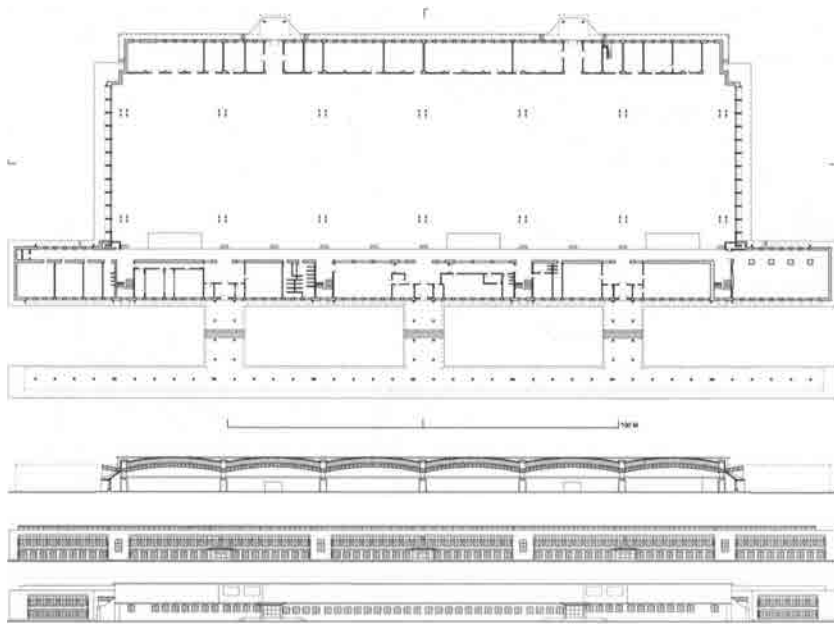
, Fig. 37, Fig. 38 y Fig. 39 Nave I de talleres. De arriba a abajo: planta baja, sección longitudinal, alzado de la fachada delantera y alzado de la fachada trasera.
